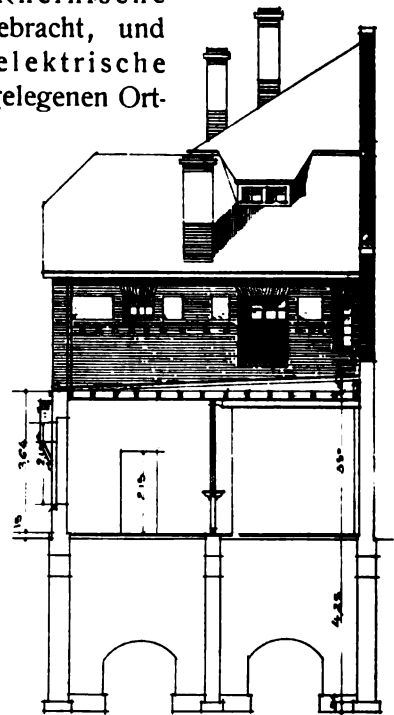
Dienstgebäude. Münsterstrasse. Seitenansicht mit Schnitt. 1:200.
